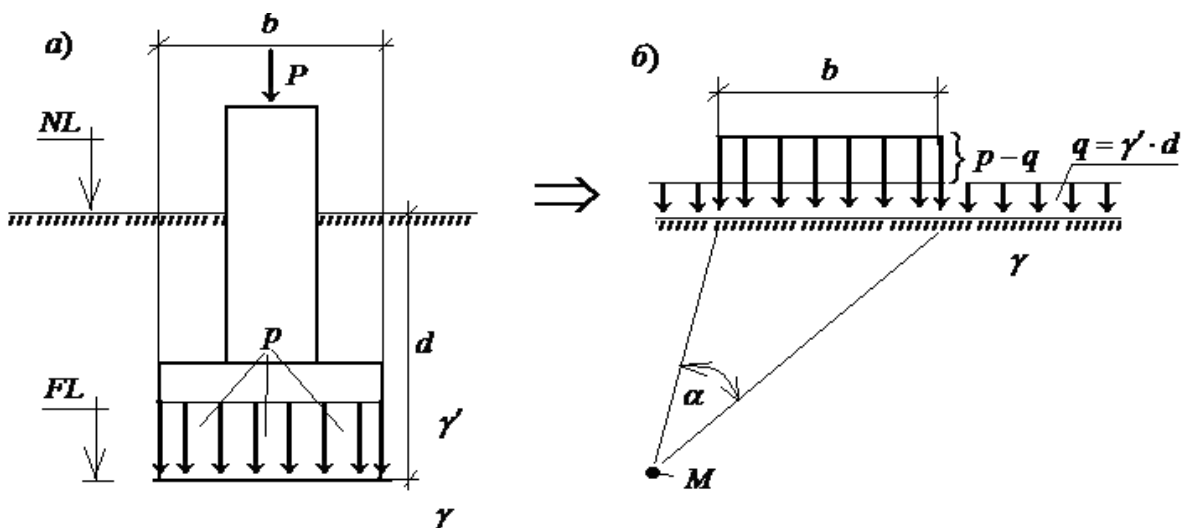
К определению начального критического давления. а– фактическая схема; б– расчетная; M – точка, в которой определяются напряжения; γ – удельный вес грунта ниже подошвы фундамента; γ' – удельный вес грунта выше подошвы фундамента; α – угол видимости; d – глубина заложения подошвы фундамента; b – его ширина
